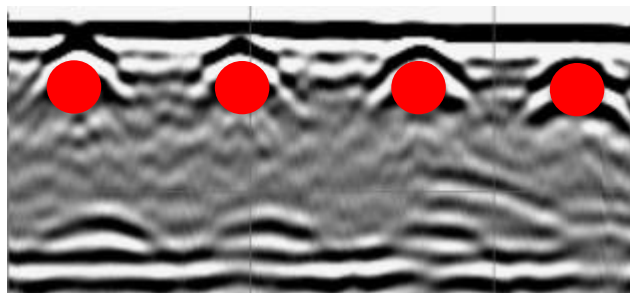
Dispunerea etrierilor în cadrul centurilor de beton armat din frontoanele din axele 1 și 9
